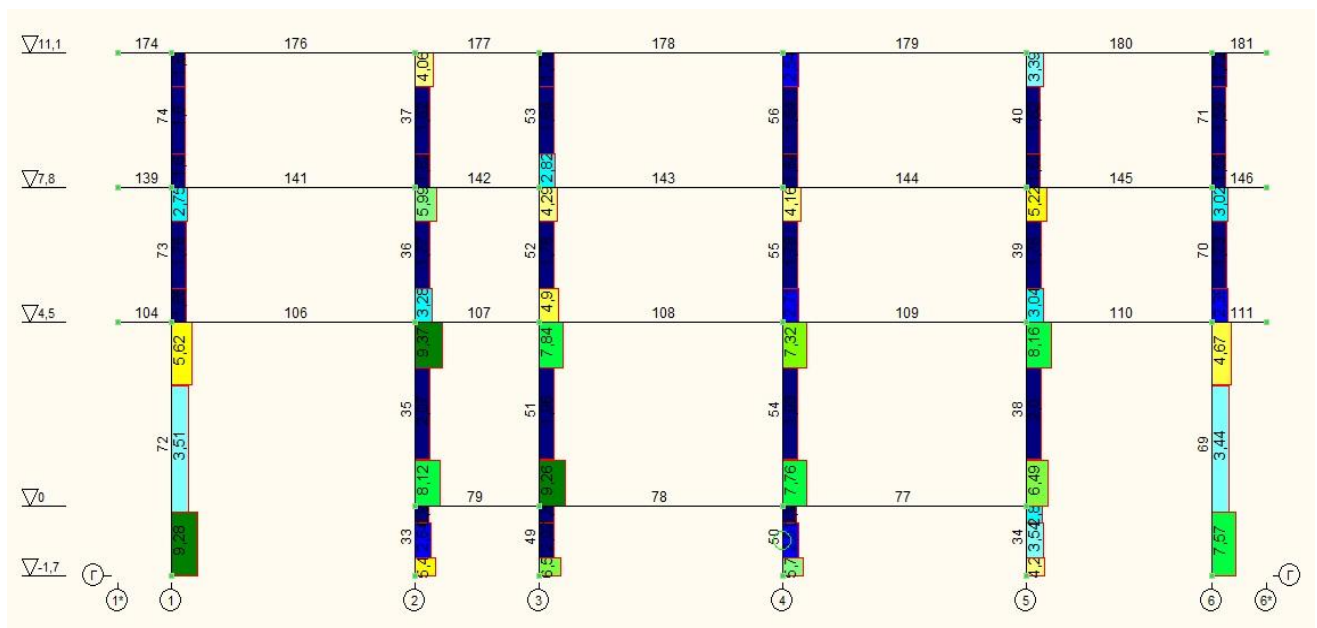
Сумарна площа поздовжньої арматури, см²
